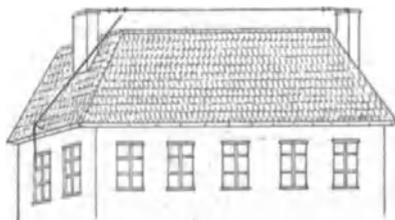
Eine häufig angewandte, nicht allzu günstige Form einer einfachen Dachantenne.
